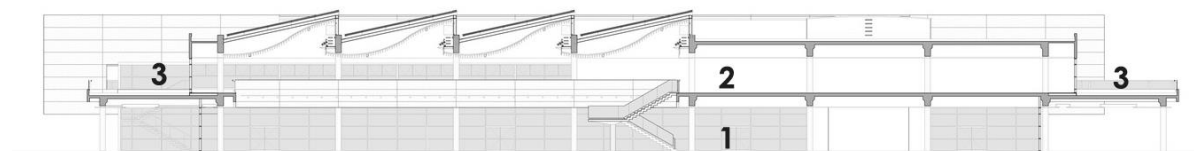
Corte transversal Biblioteca São Paulo. Fonte: Archdaily(2019b).
